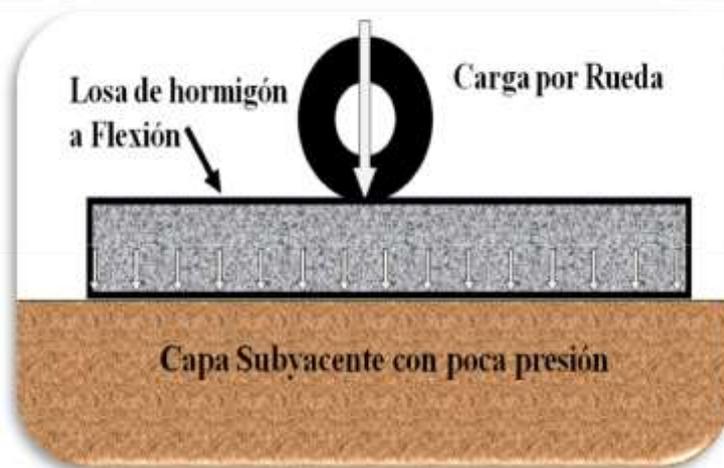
Distribución de la Carga en Pavimentos Rígidos.
